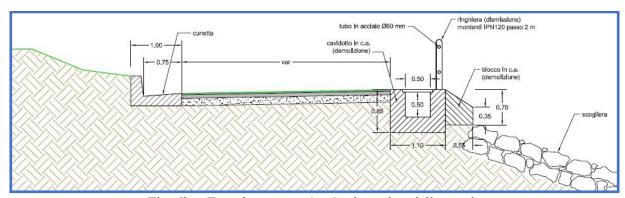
Zona intervento 1 – Sezione tipo della strada
